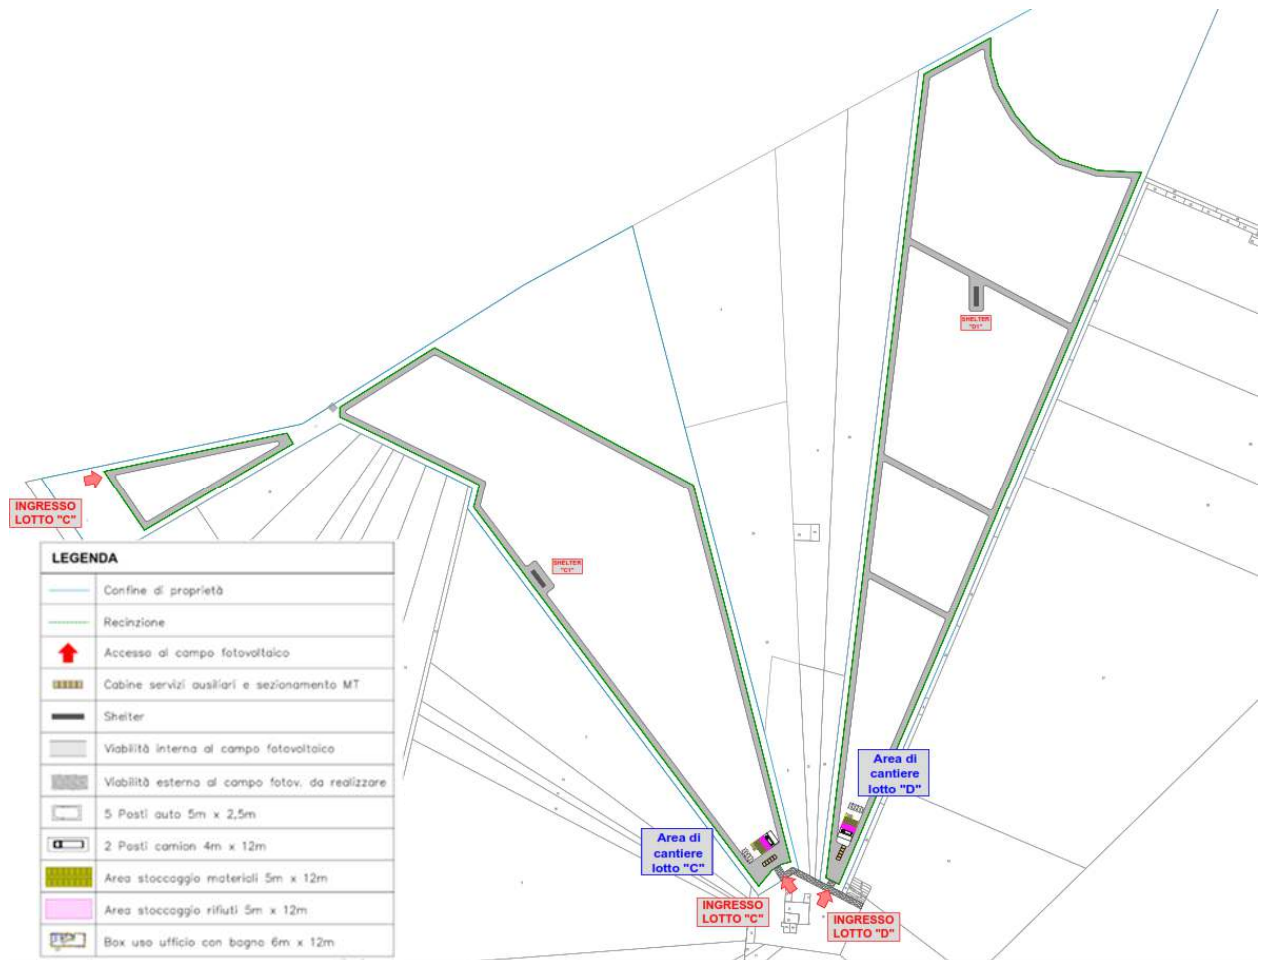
Posizionamento area di cantiere temporaneo Blocchi "C" – "D"
